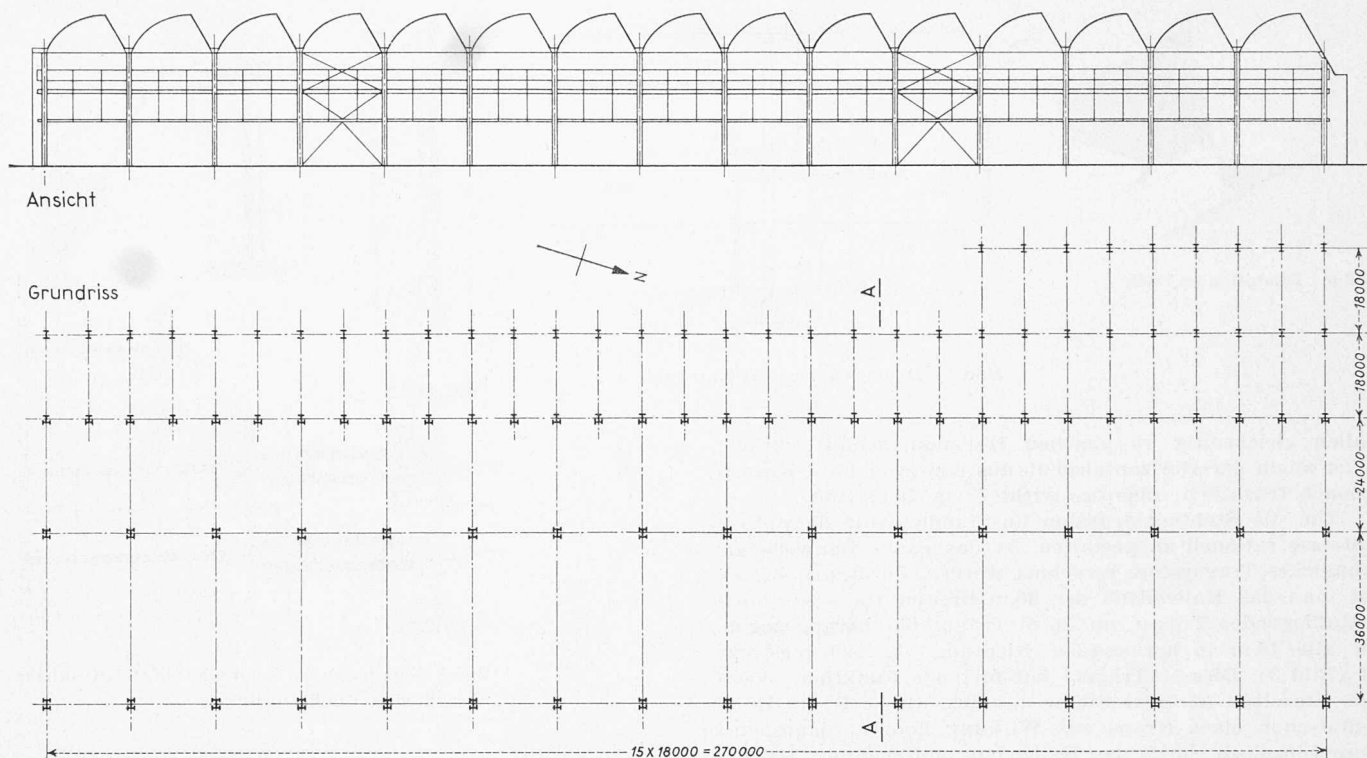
Ansicht und Grundriss der bisher erstellten Fabrikhallen im Birrfeld, Masstab 1 : 1600
